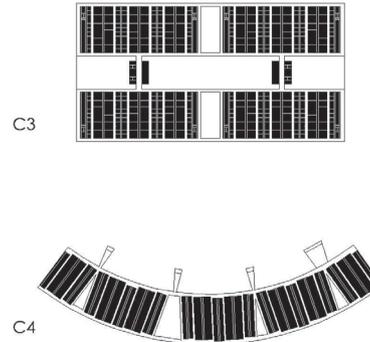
El campus compacto 2. Arriba, planta de los laboratorios Bell de Saarinen, 1957-62. Abajo, planta del centro de IBM en Yorktown de Saarinen, 1956-61.
